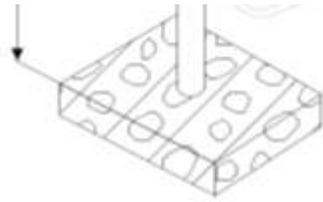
Schizzo della fondazione in calcestruzzo
